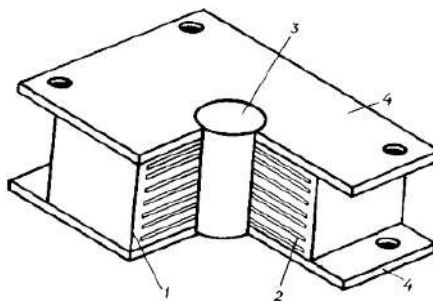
Конструктивная схема резинометаллической опоры со свинцовым сердечником
